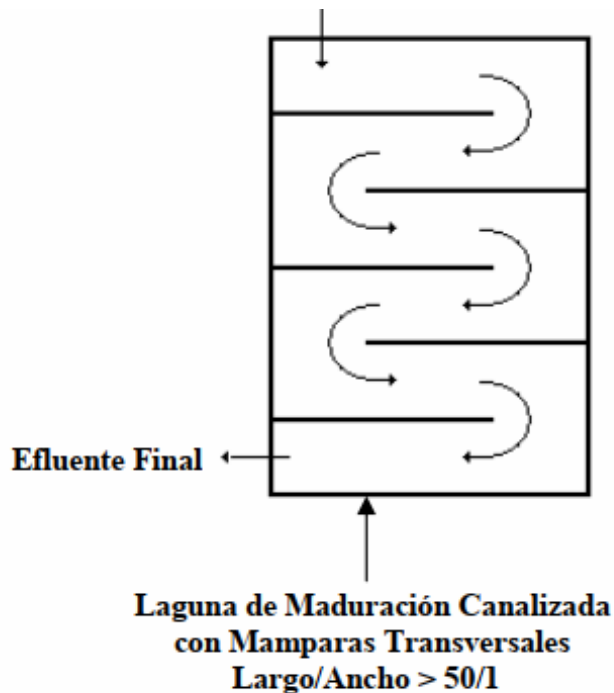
Vista de planta de la laguna de maduración con mamparas para aumentar su relación largo/ancho. Fuente: Oakley, 2005
